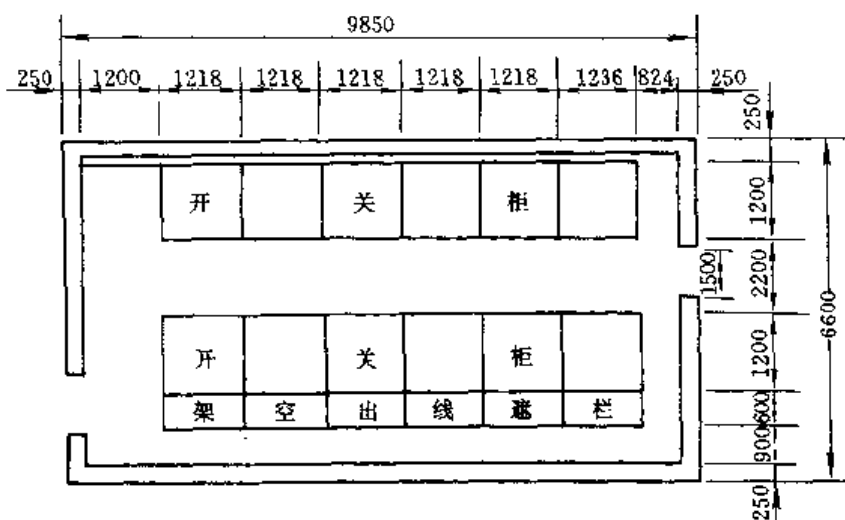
10kV 室内配电装置平面布置图（单位：mm）
